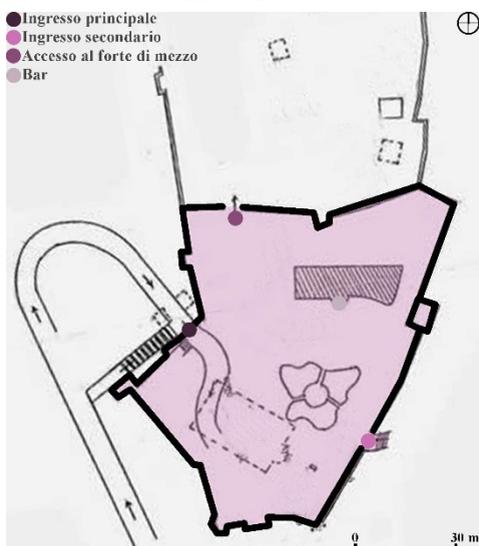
Il Castello di Trikala, planimetria generale della rocca inferiore (Adriana Trematerra, 2023)
